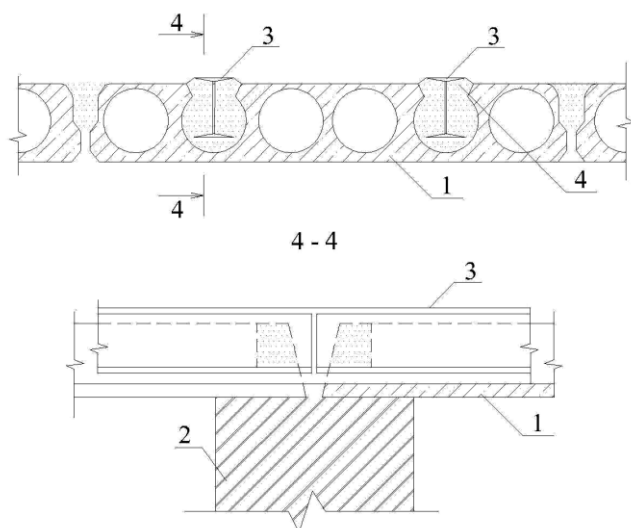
Підведення металевих розвантажувальних балок зверху: 1 – підсилювані плити; 2 – опора (блок або балка); 3 – розвантажувальні балки з двотаврів; 4 – вирубані полиці плит для встановлення балок
